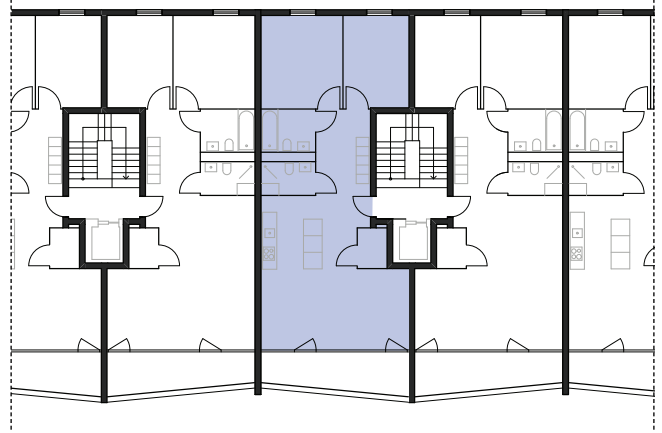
Grundrissausschnitt des Wohngebäudes Jolimont mit Erschließung über den Treppenraum
